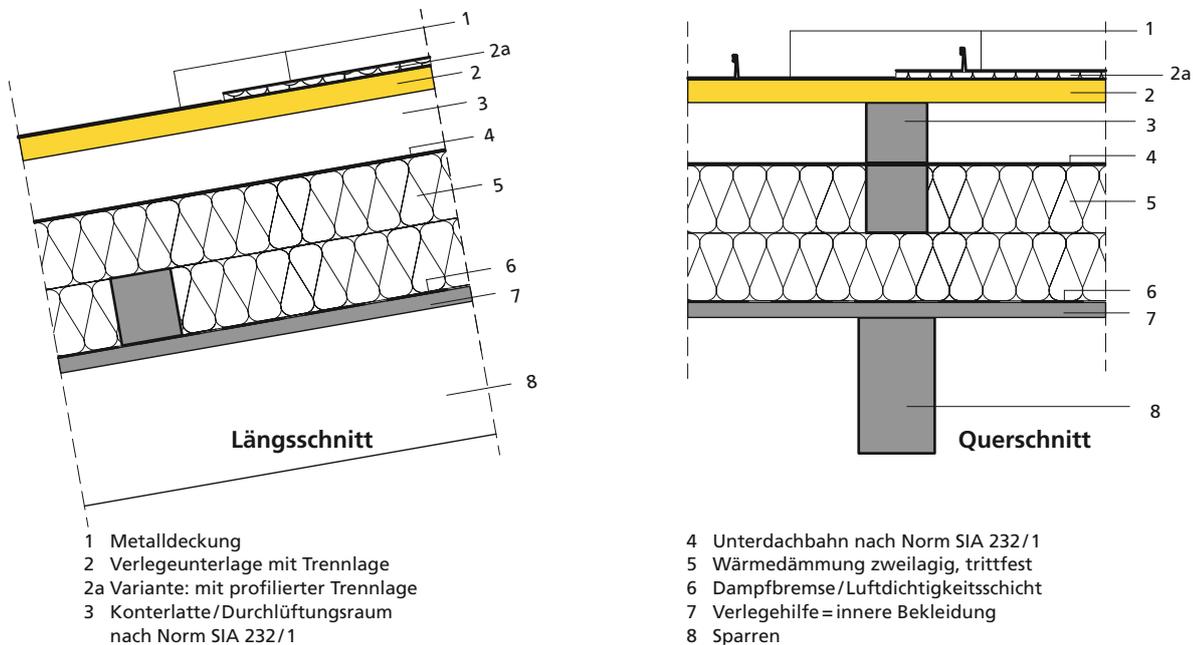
Einfach bzw. doppelt belüfteter Dachaufbau mit Unterdachbahn auf Verlegehilfe (gelb = Verlegeunterlage)
